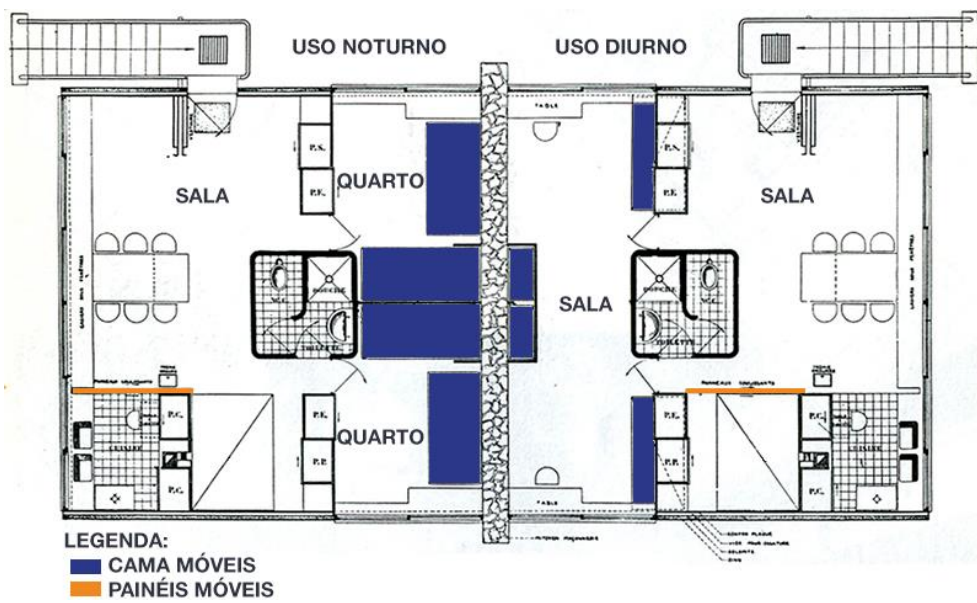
Casa Loucheur, Le Corbusier e Pierre Jeanneret, não construída, 1928-9
